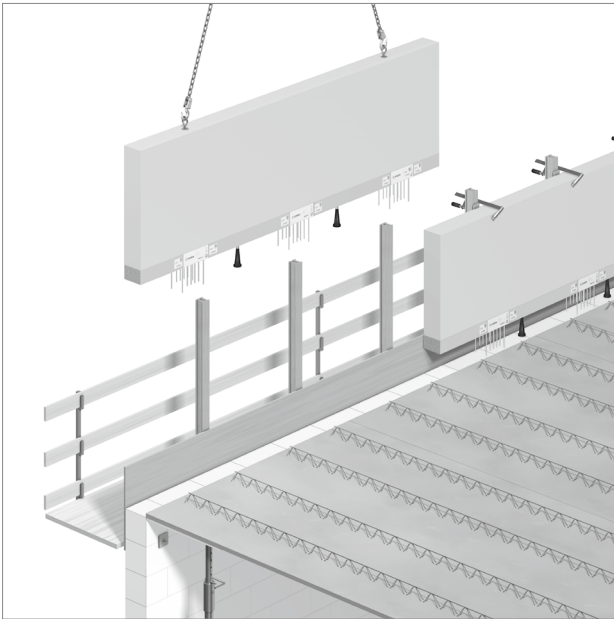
Schöck Isokorb® CXT Typ A mit Combar® Fertigteil-Montagestütze: Einheben der Fertigteilattika
